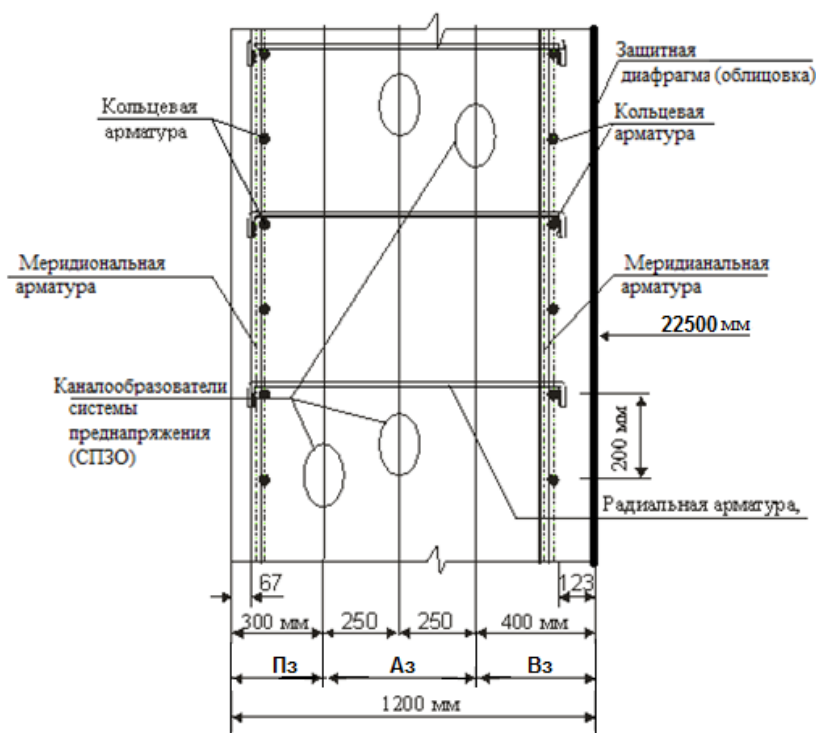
Поперечное сечение цилиндрической части ЗГО
